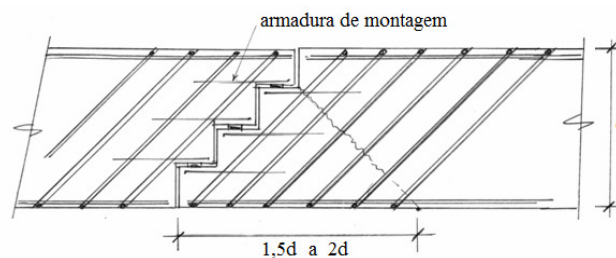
Detalhe das armaduras internas propostas para vigas de concreto armado.
